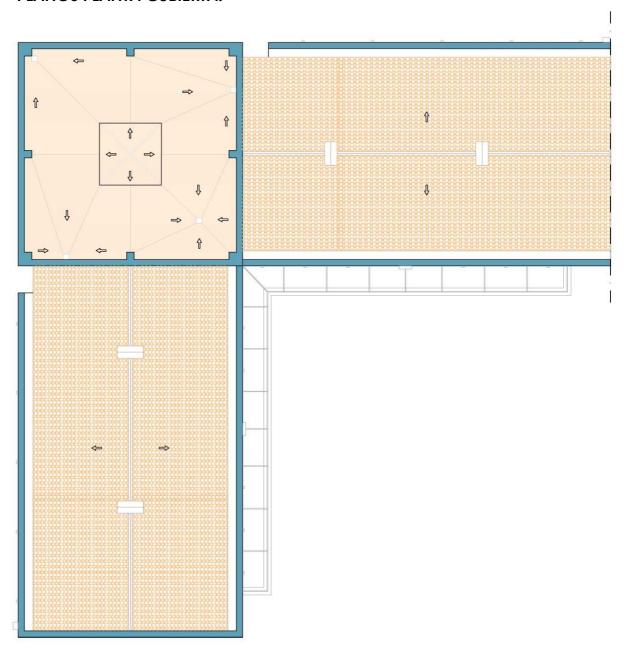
Plano Cubierta; bloques 10 y 11.21
